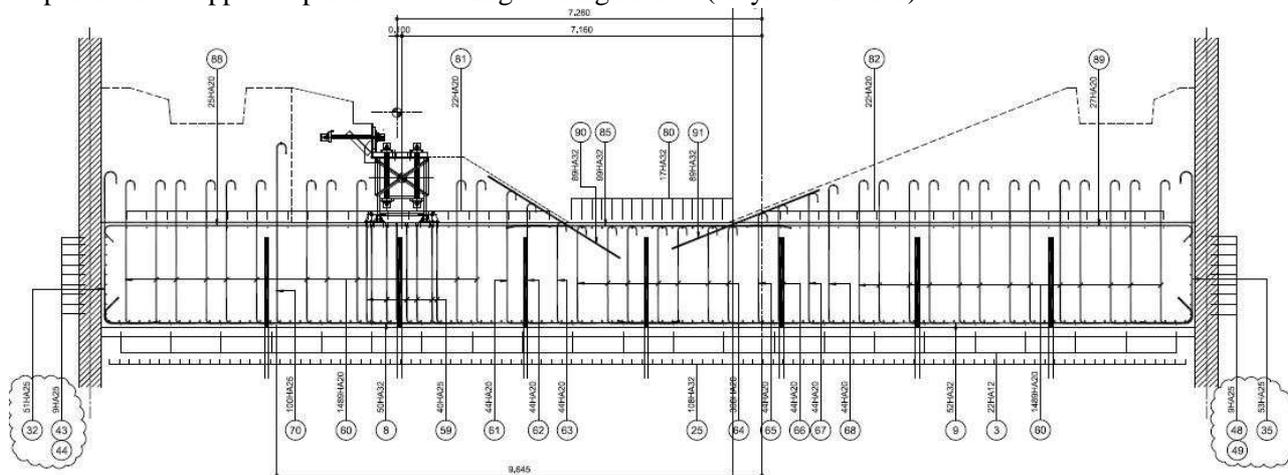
Coupe transversale du ferrailage du radier du barrage de Chatou
